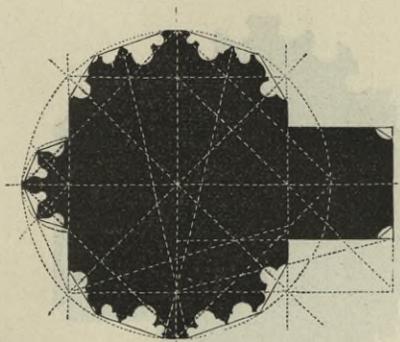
Profil eines Pfeilers aus dem Langhause.
